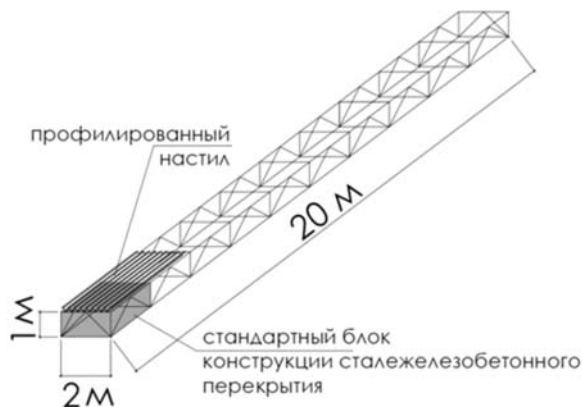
Монтажный блок перекрытия малопроектного здания-моста
